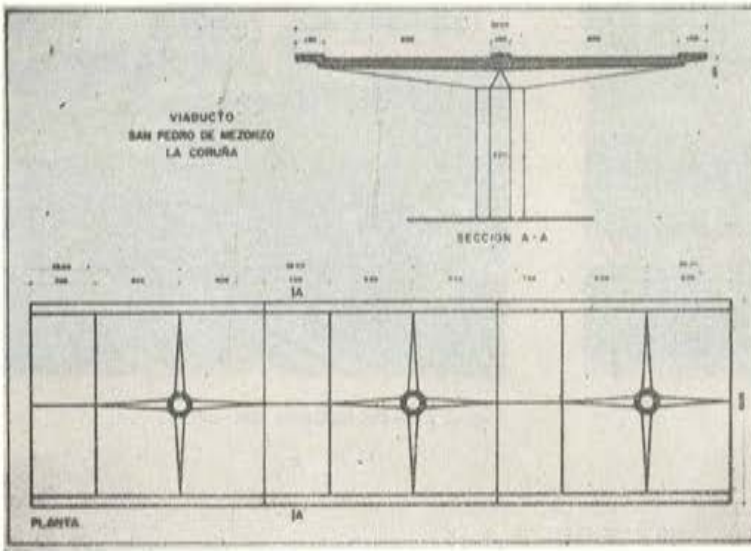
Puento de San Pedro de Mezonzo, Planta parcial y sección transversal.
